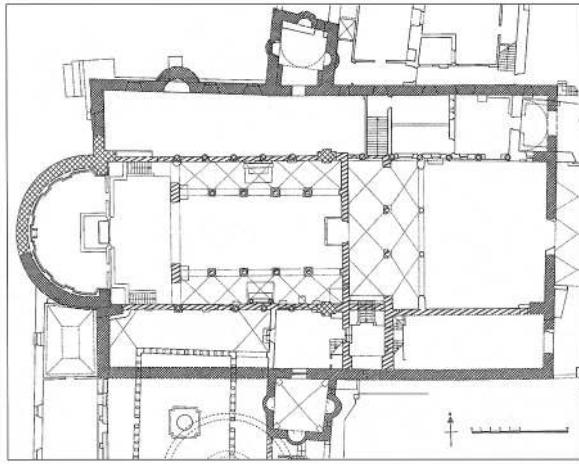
Rom, SS. Quattro Coronati, Grundriss mit Bauphasen.
